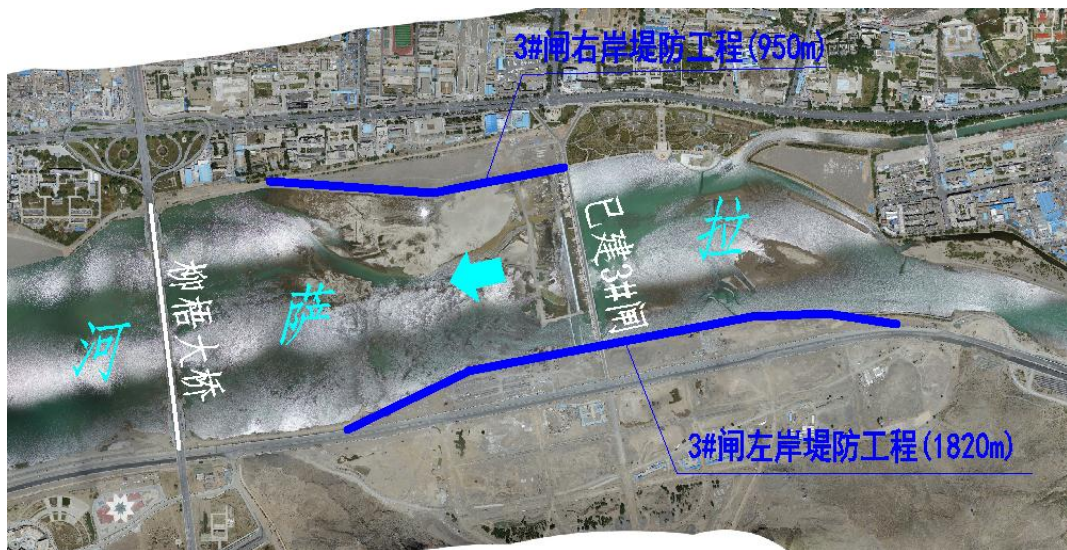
3#闸两岸堤防工程平面布置示意图
